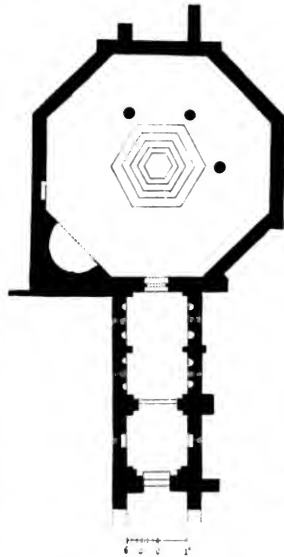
Baptisterium zu Aquileja. Grundriss.
